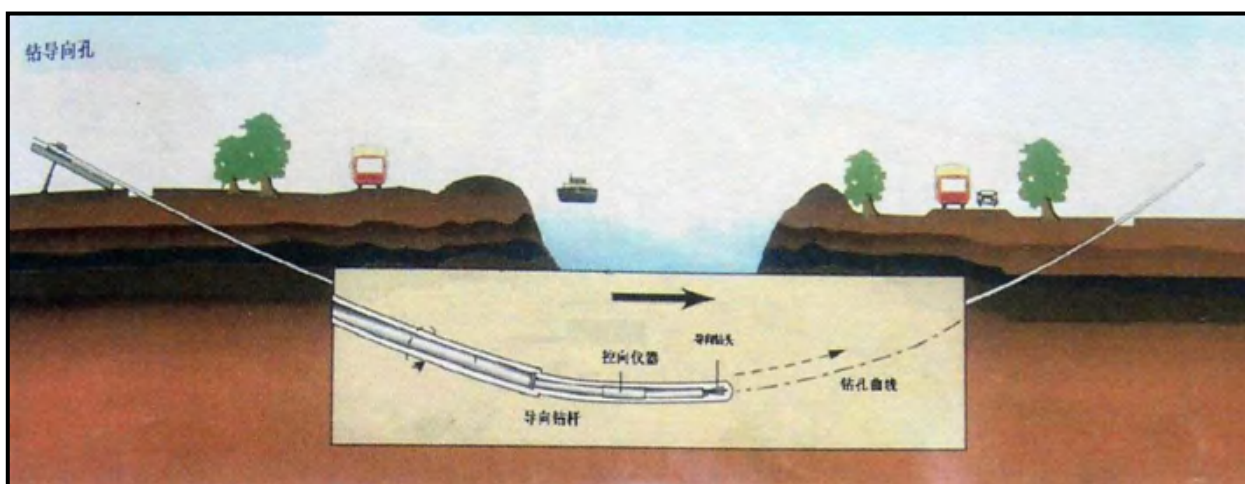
定向钻穿越施工钻导向孔过程断面示意图
